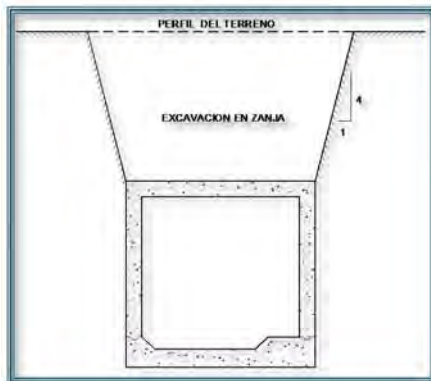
ESQUEMA EXCAVACIÓN EN ZANJA
